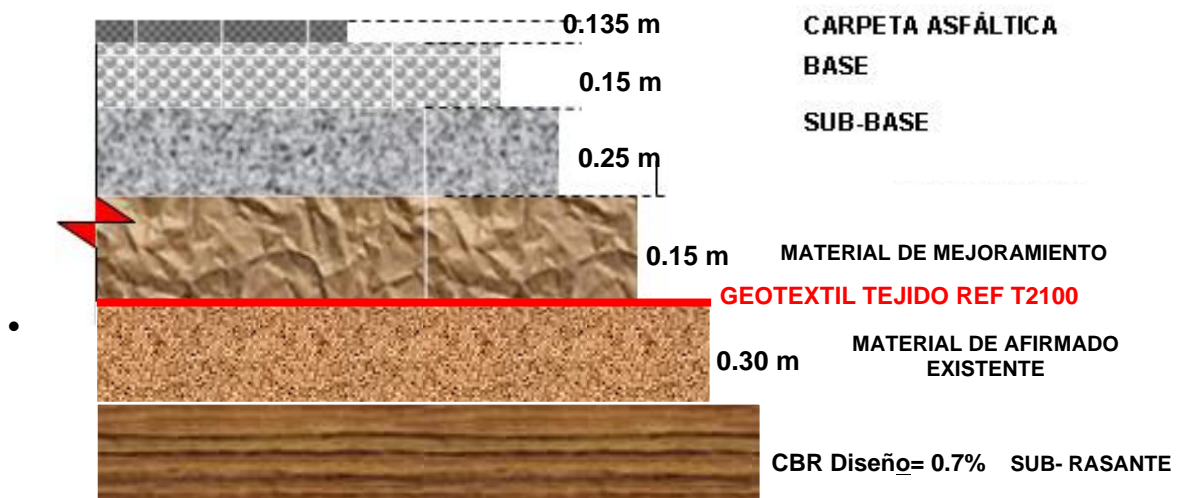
Dimensionamiento de la estructura en pavimento flexible para la unidad de diseño N°2 del tramo N°1
